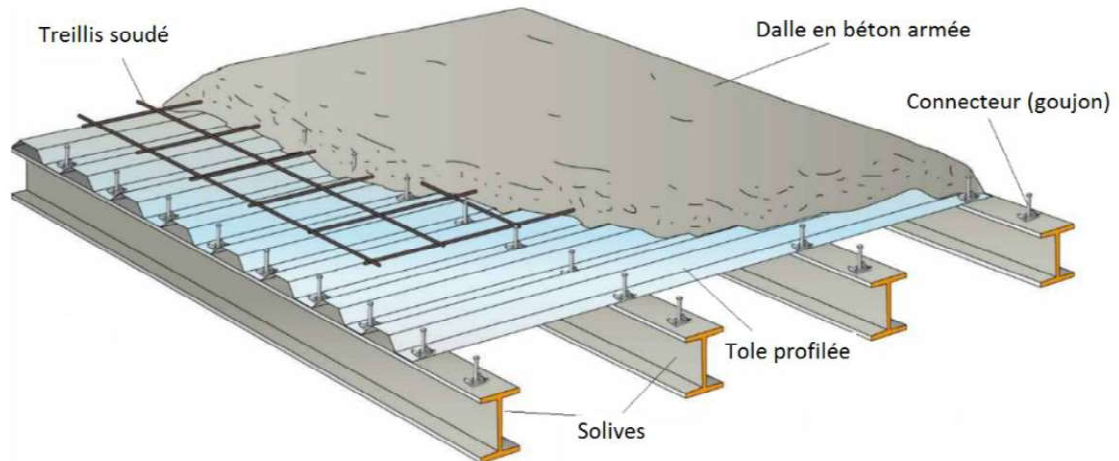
Plancher mixte acier-béton (plancher collaborant).
